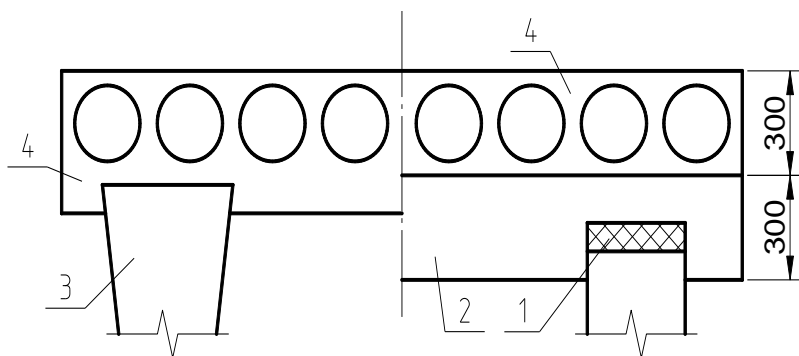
Конструктивные решения плитно – свайных фундаментов:
